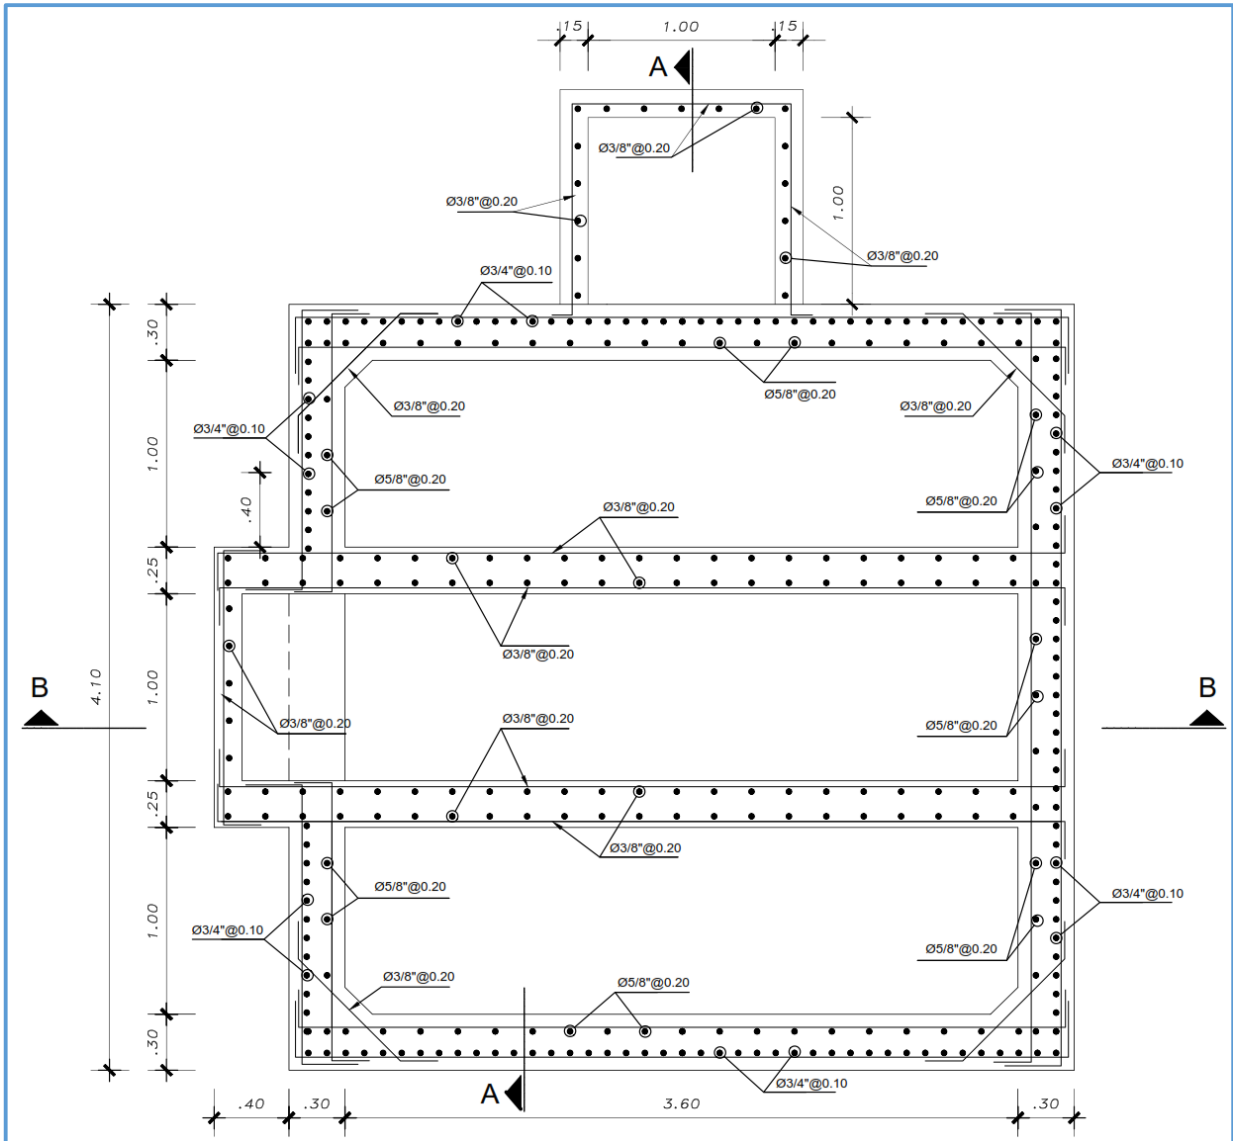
Vista de los muros en planta del tanque imhoff de los reforzamientos
